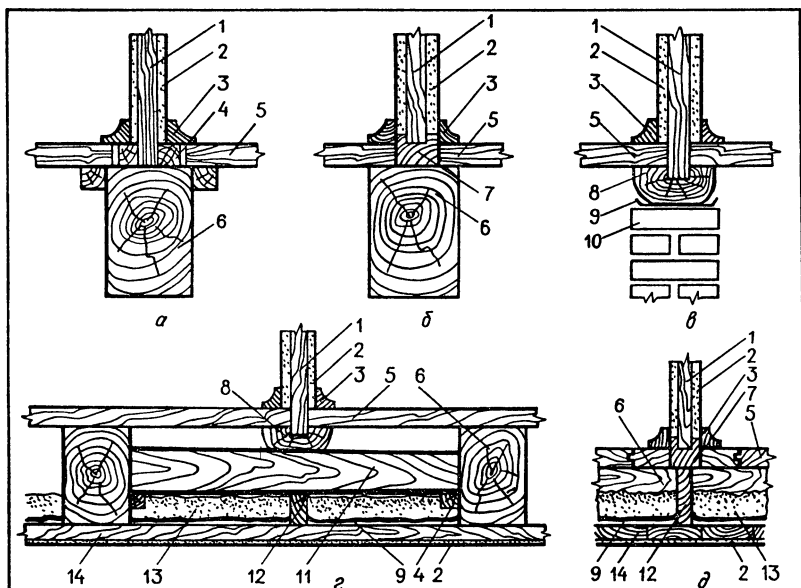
Опираие перегородок при размещении их вдоль балок (а...г) и поперек (д):
